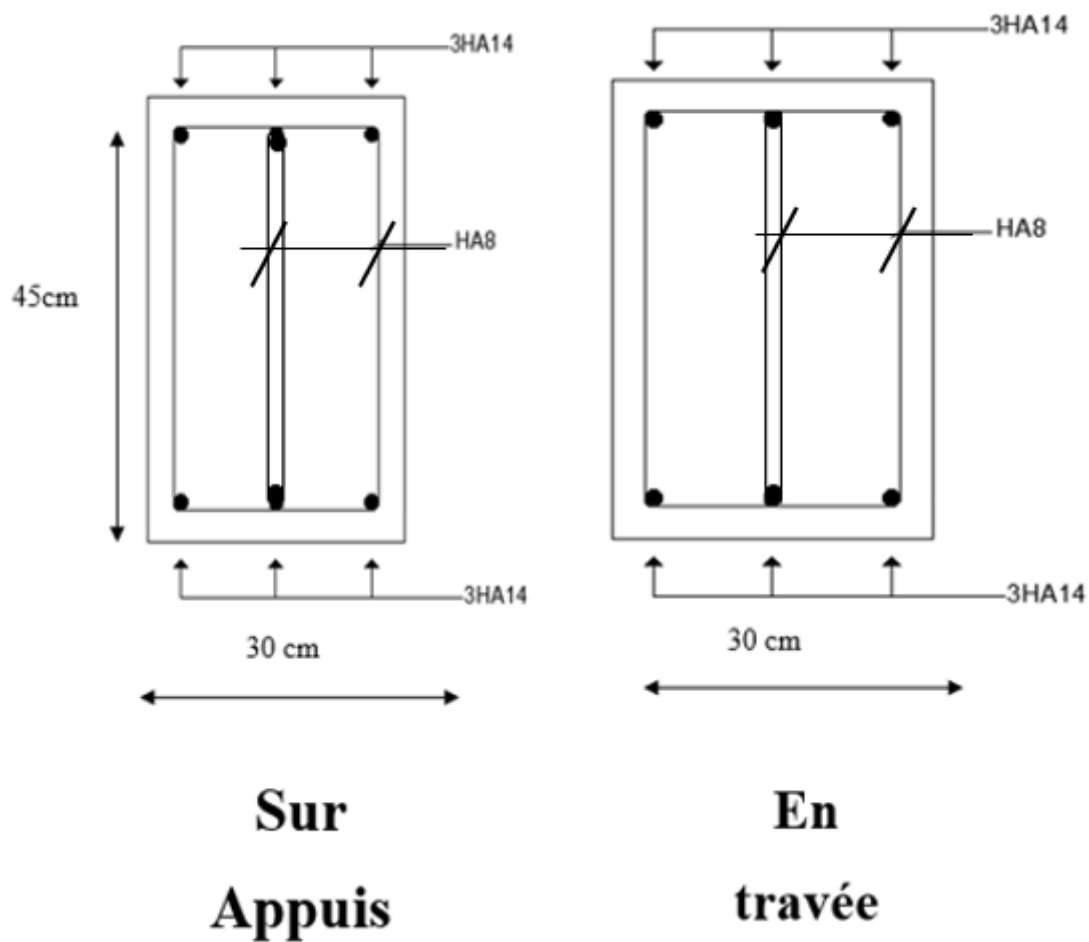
Coupe de ferrillage des poutres principales au niveau d'appuis et travée(étage courante)
